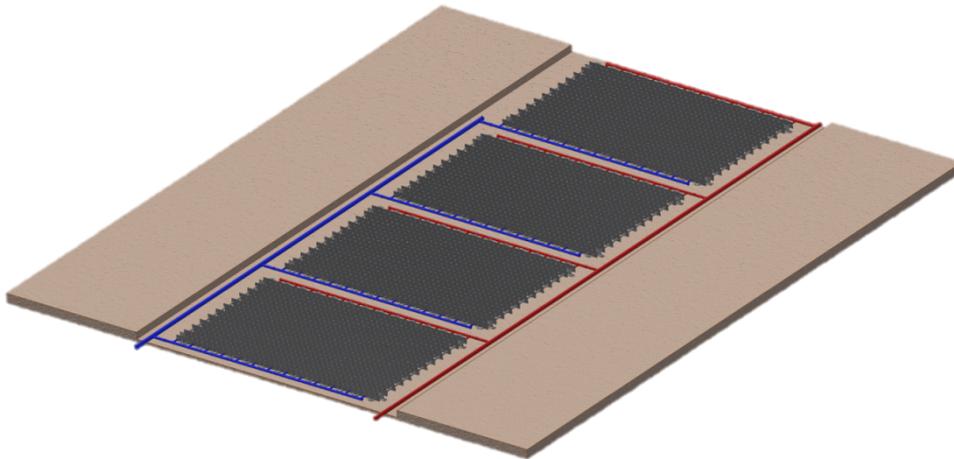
Verlegeplan Kombination Wärmetauscherelemente
